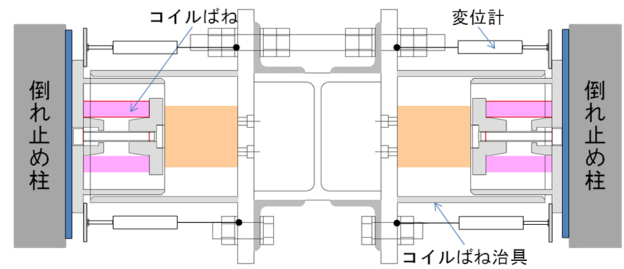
コイルばねによる補剛 (TRUSS5, TRUSS6)
